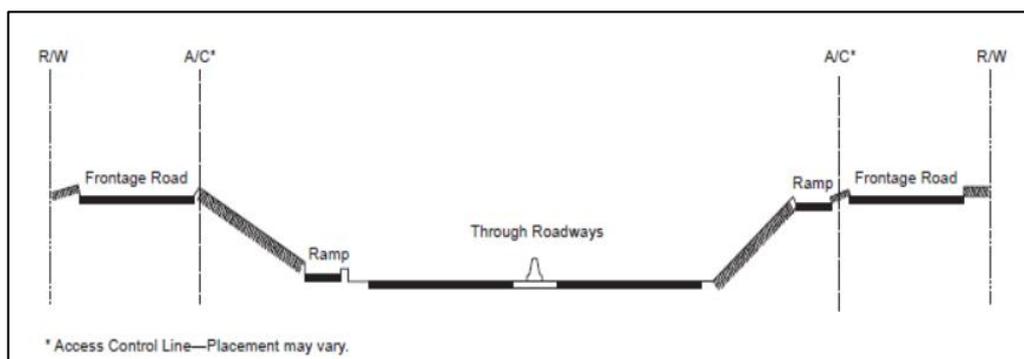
13: Sección transversal típica de una vía expresa tipo zanjón
